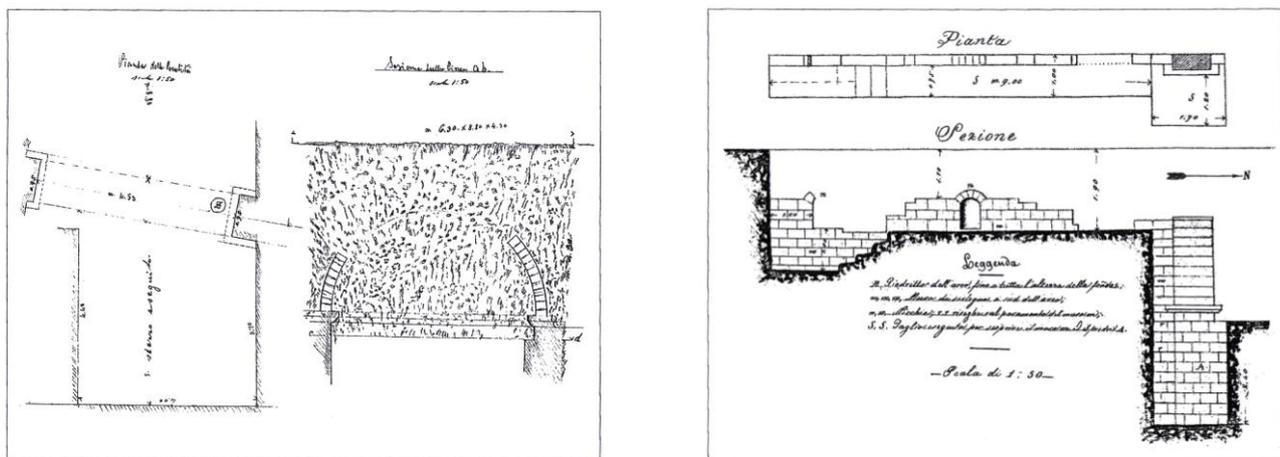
Rilievo planimetrico e prospettico della struttura ad arco e del muraglione (da CERA 1998, figg. 1-2).
